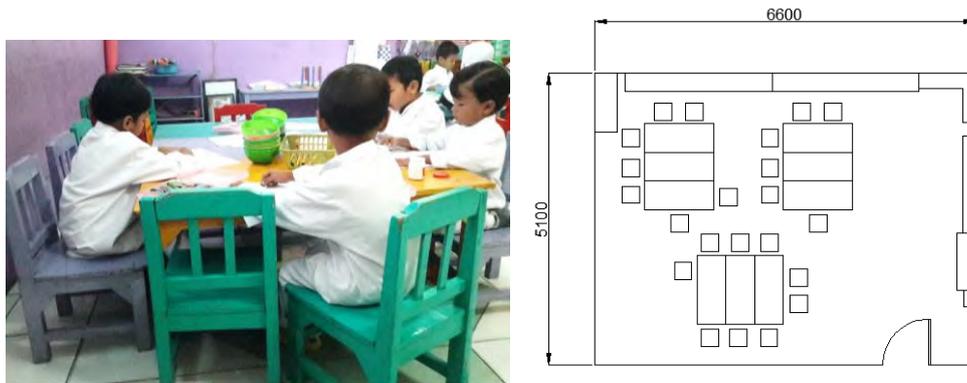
Ruang Kelas dan Layout Kelas TK Pertiwi Teladan
